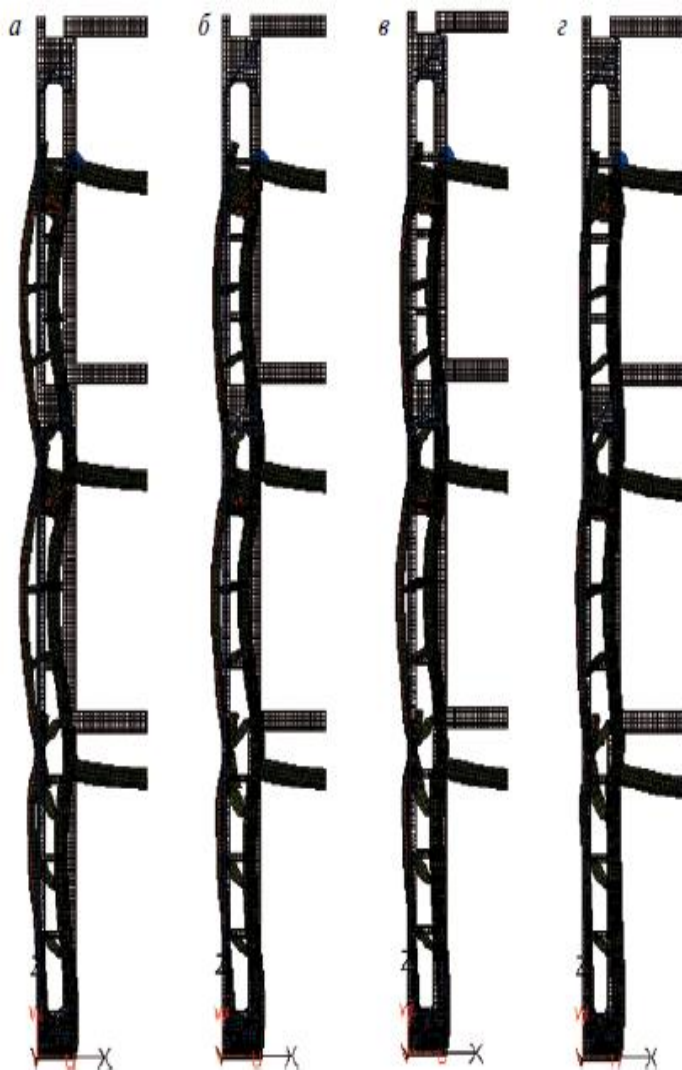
Перемещения наружных трехслойных стеновых панелей:
